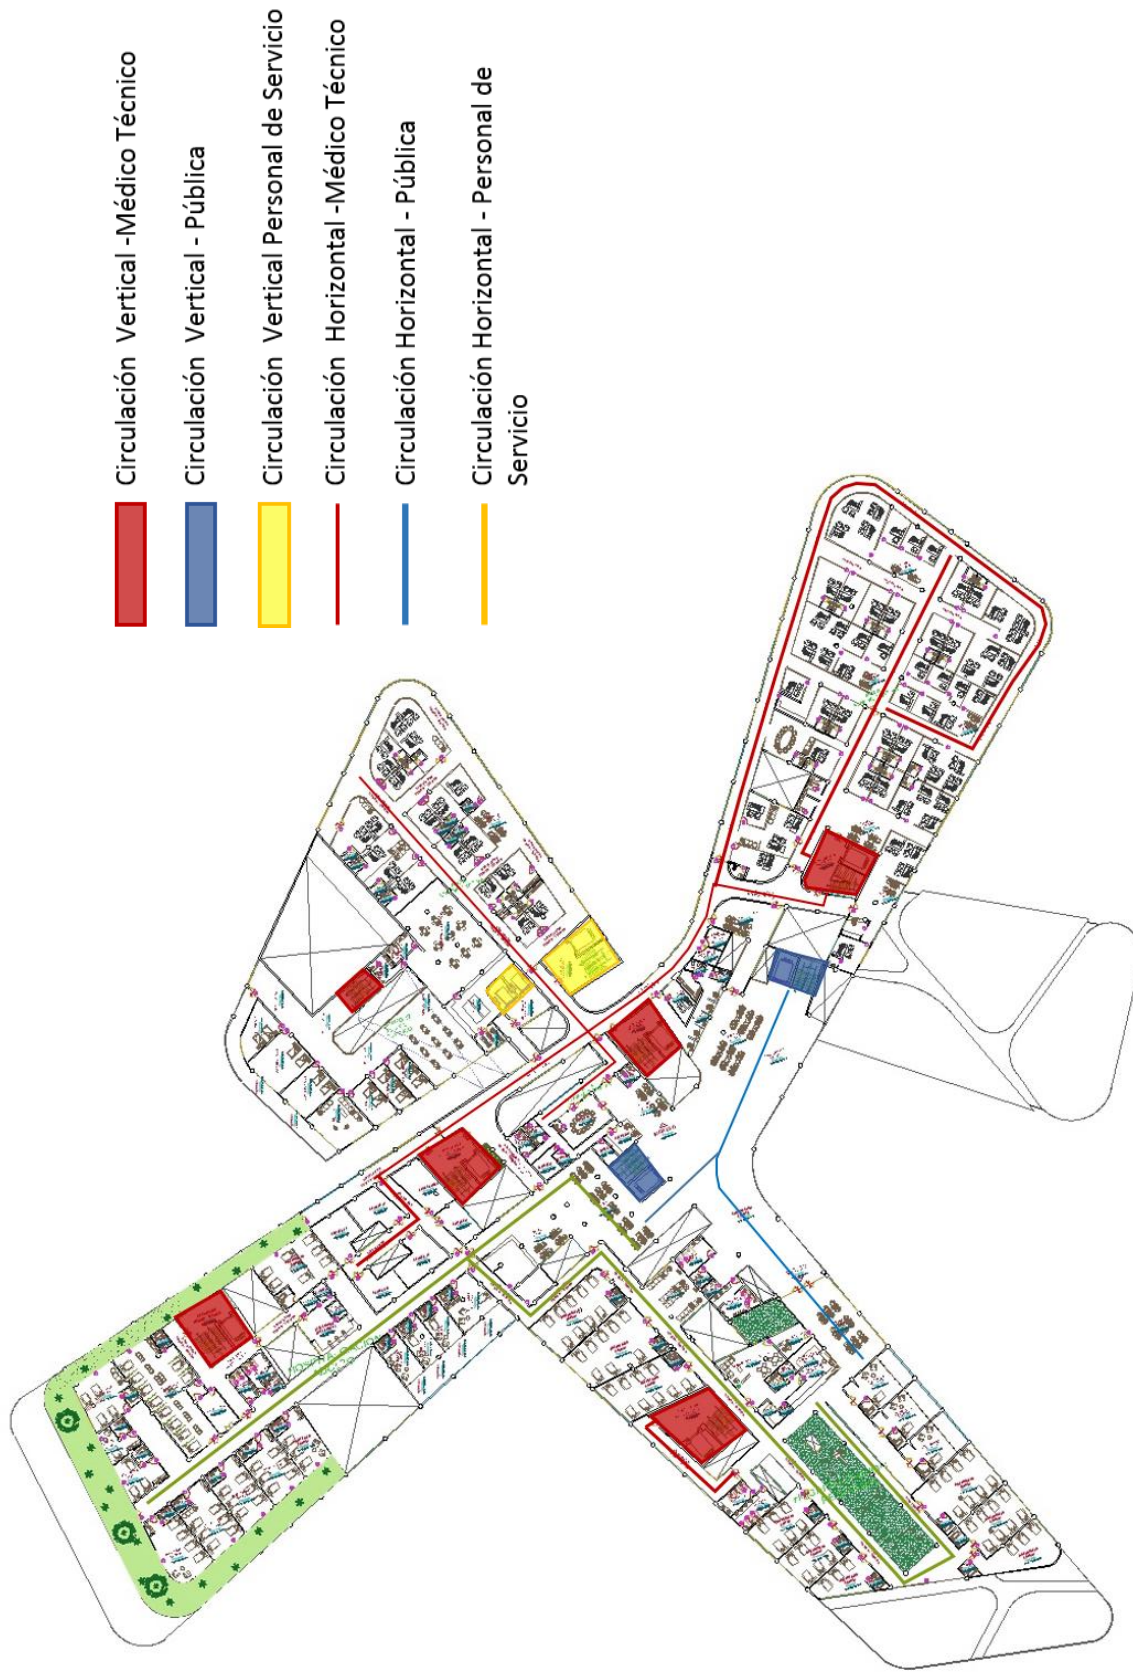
Circulación de Tercera Planta de la Propuesta Arquitectónica.
